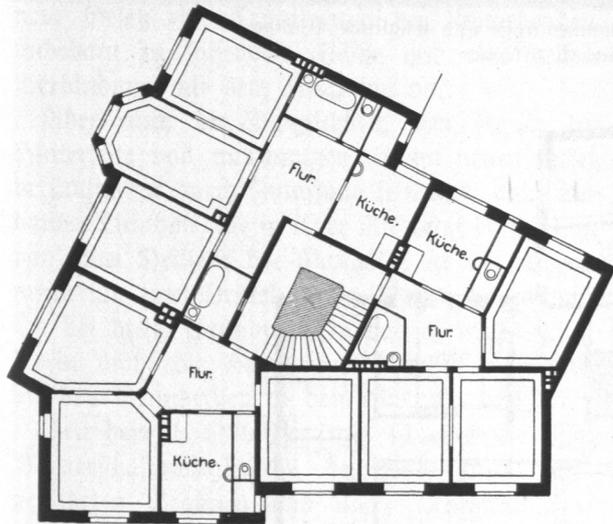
Haus Moorweidenstraße Nr. 34, Obergeschoß.
